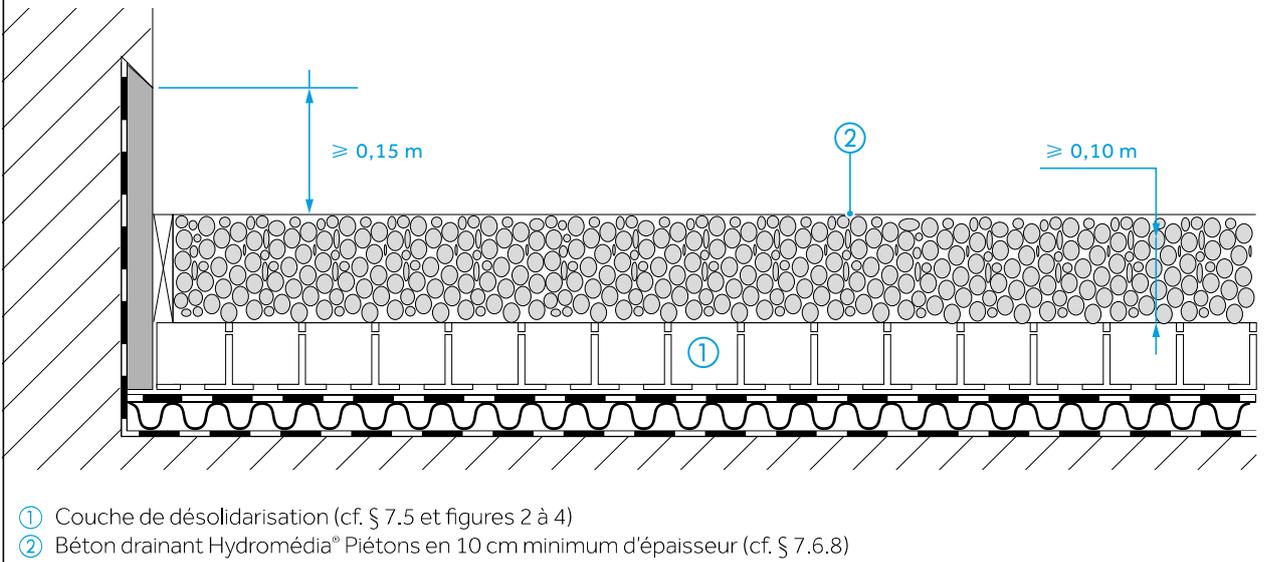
Toiture accessible aux piétons avec dalles en béton drainantes
